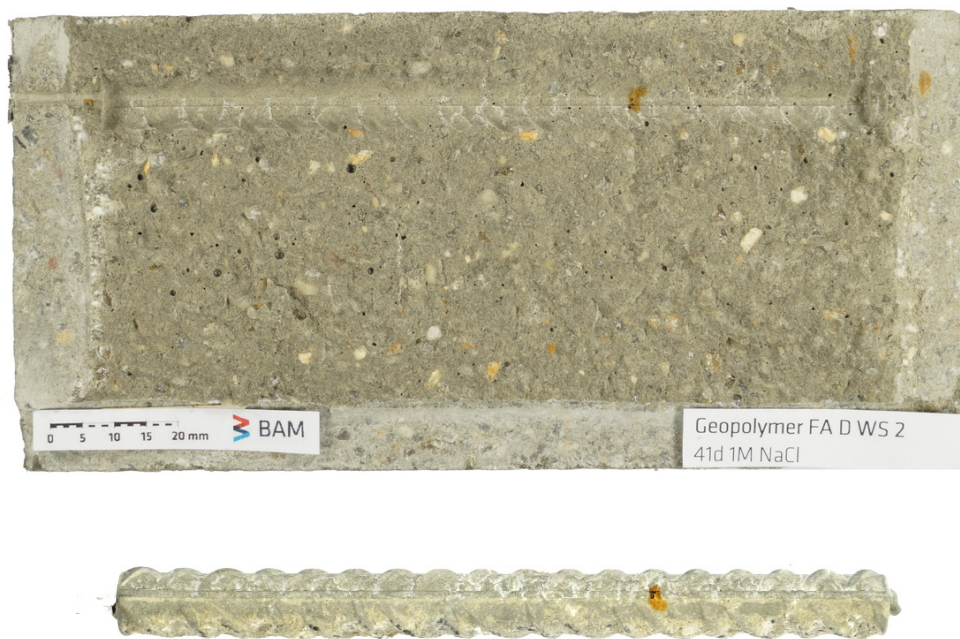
Foto von gespalteener FA D WS 2 Probe und Bewehrungsstahlzustand nach Depassivierung.
